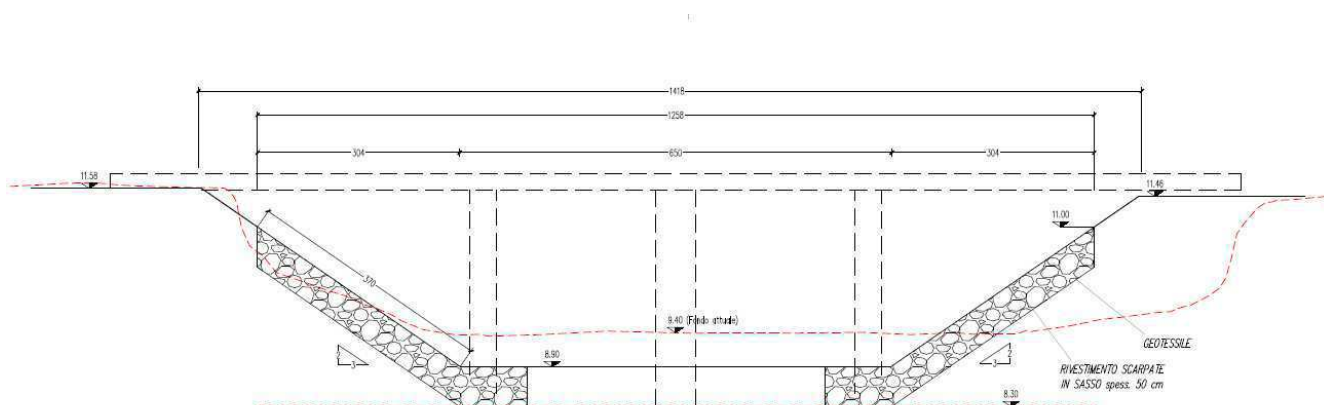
Sezione Canale Naviglio, stato di fatto e di progetto
